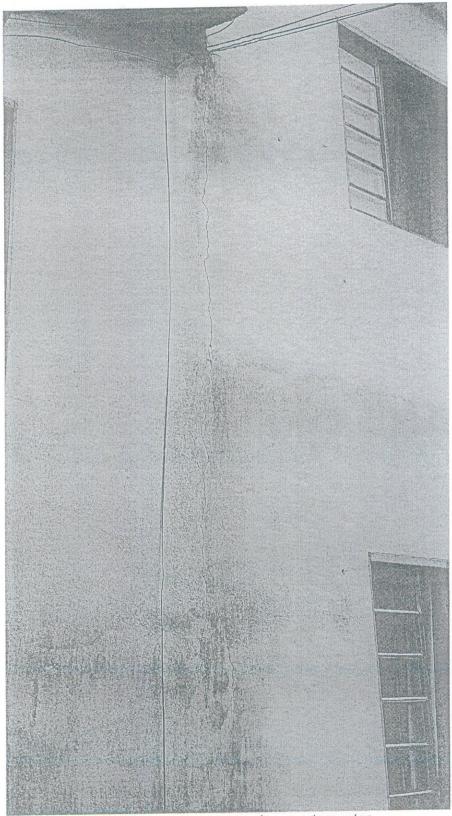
Fissura em parede externa dos apartamentos
